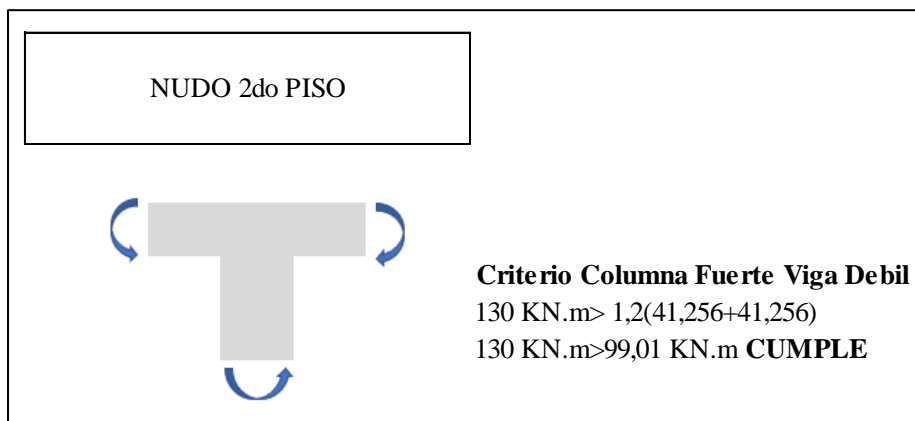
Criterio viga fuerte y viga débil de la columna C5
